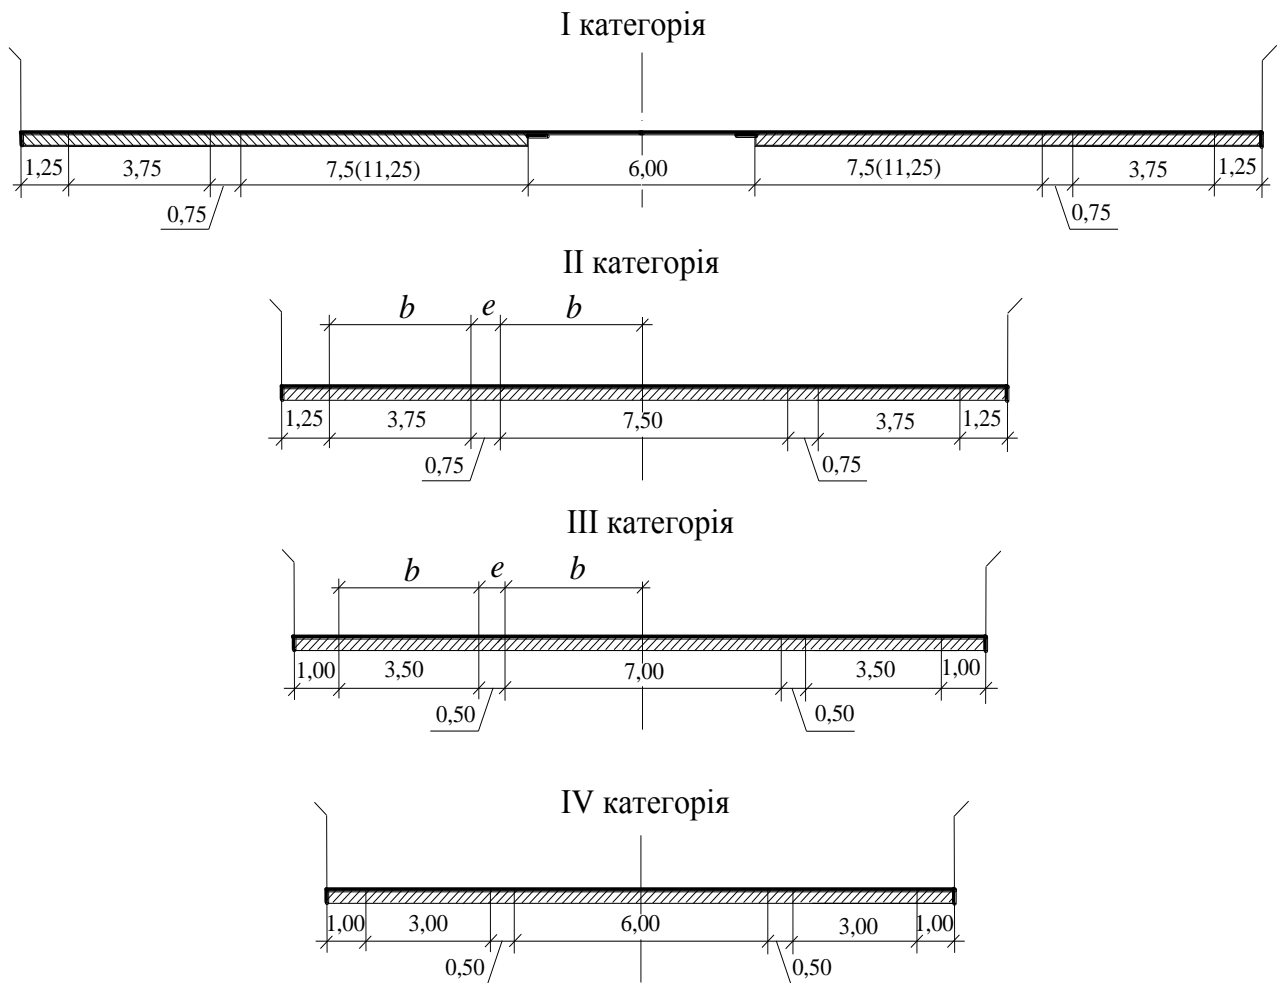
Схеми поперечних перерізів шляхопроводів на розв'язках доріг
